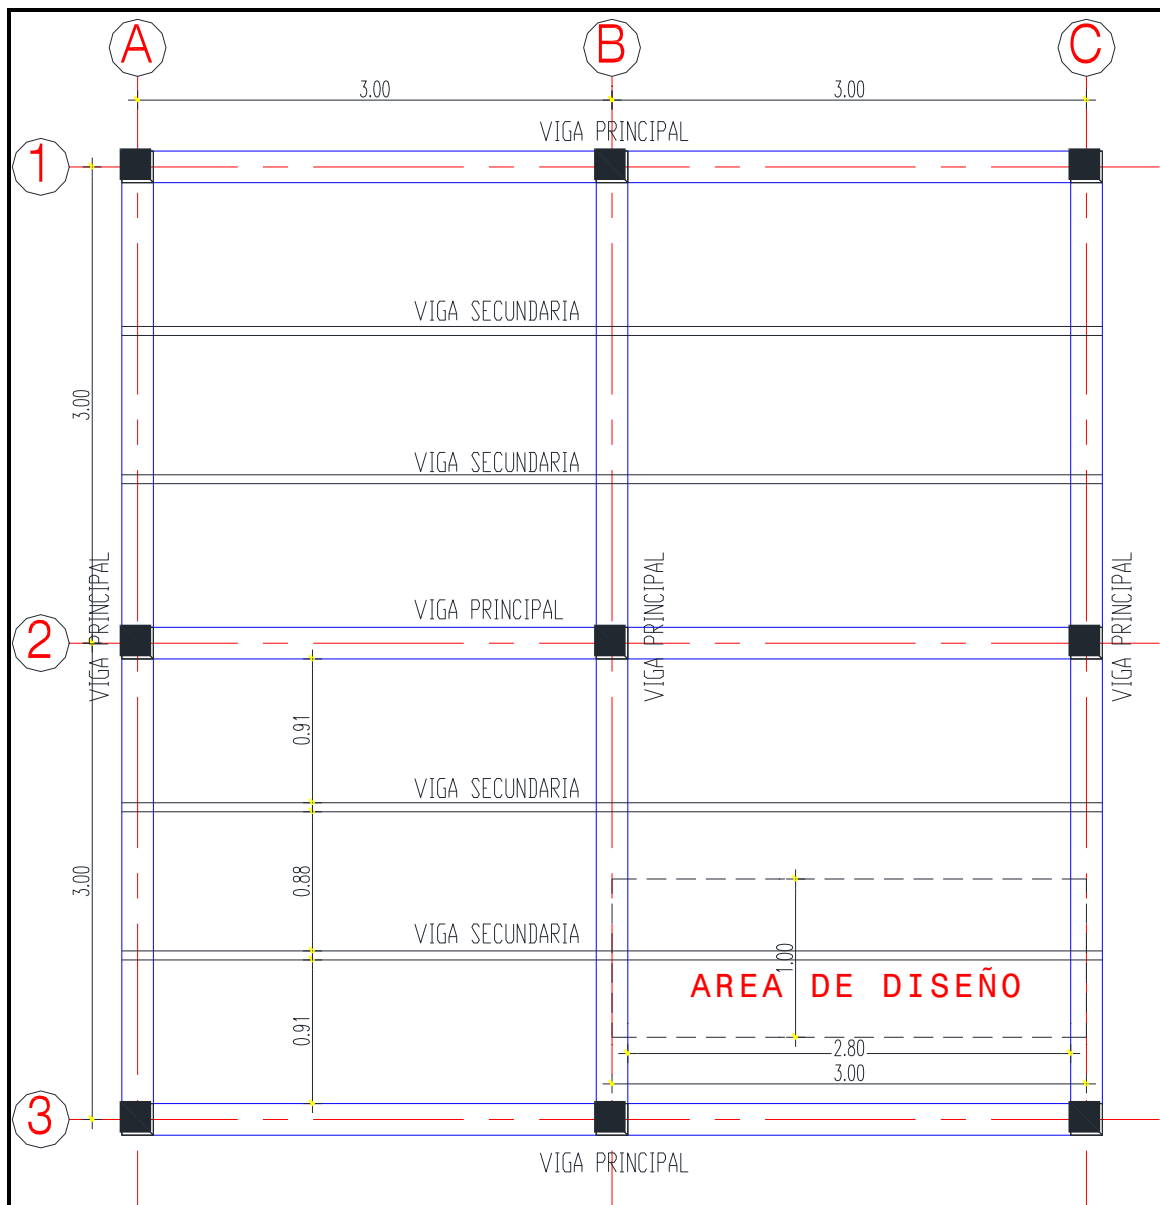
CONFIGURACIÓN ESTRUCTURAL.
